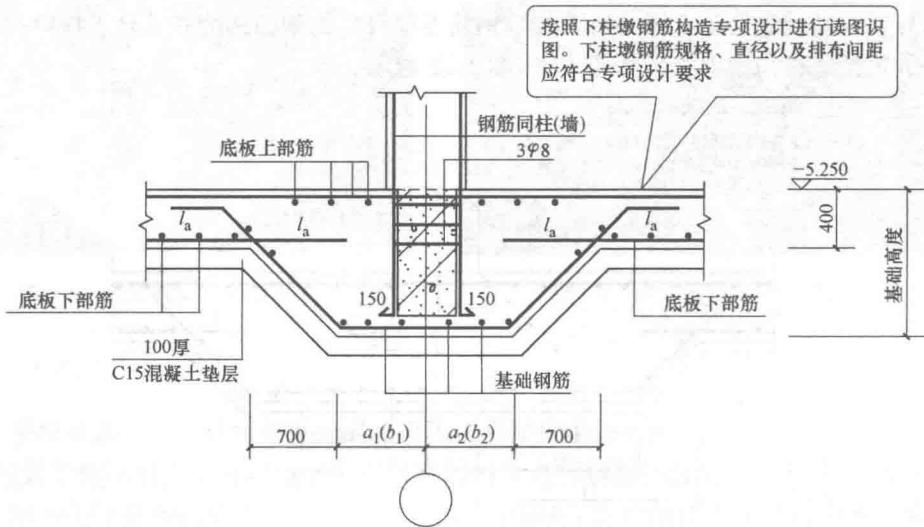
基础下柱墩钢筋构造 (2) 2-2 剖面图
